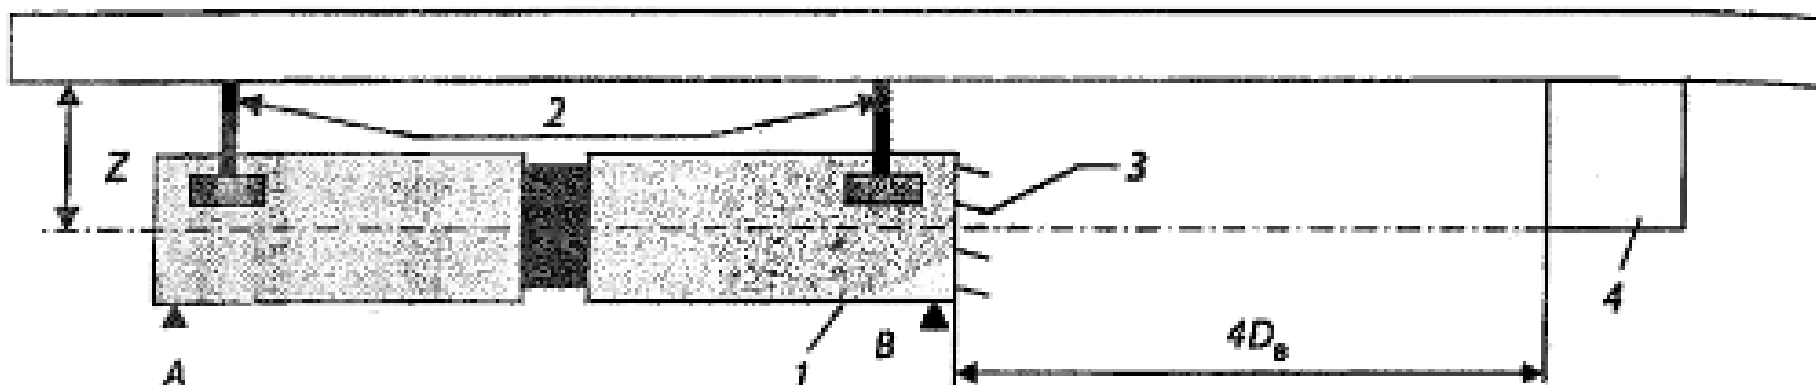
Схема установки монтажа осевого бесканального вентилятора на потолочном перекрытии
